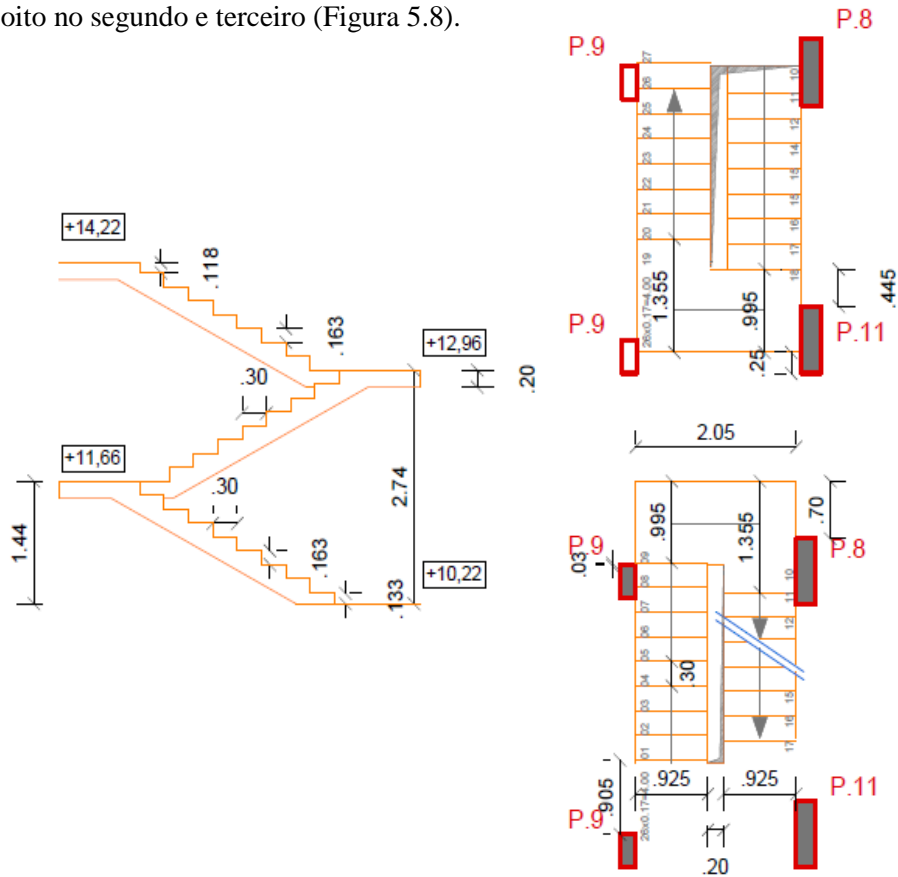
Planta e corte da escada do lote 6.6, piso -1.
